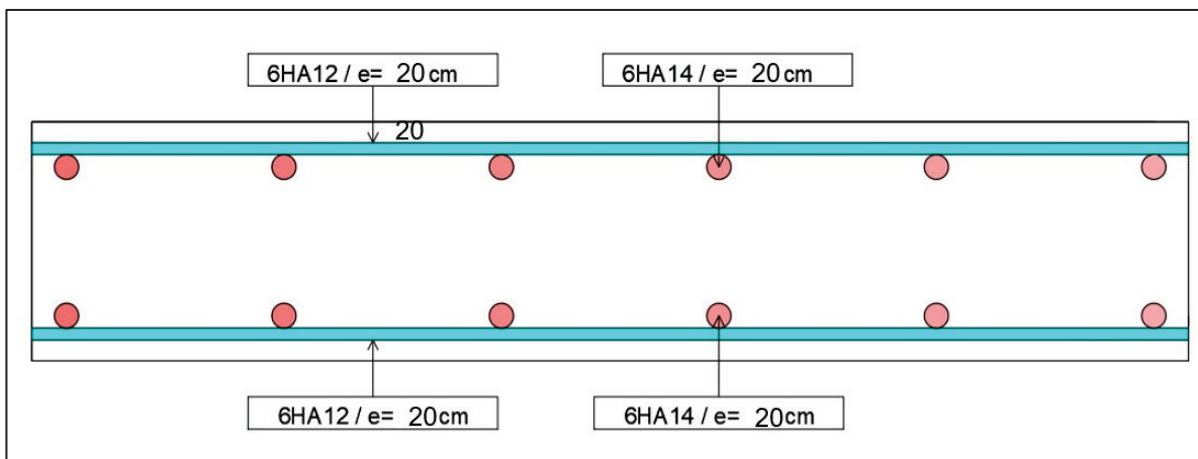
FERRAILAGE DE LA DALLE.
